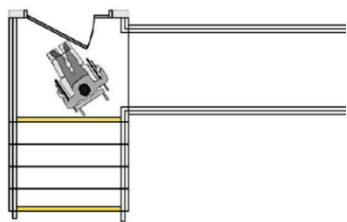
Вариант недоступной входной площадки (площадка недостаточных габаритов, на которой инвалид на кресле-коляске не сможет открыть входную дверь)
